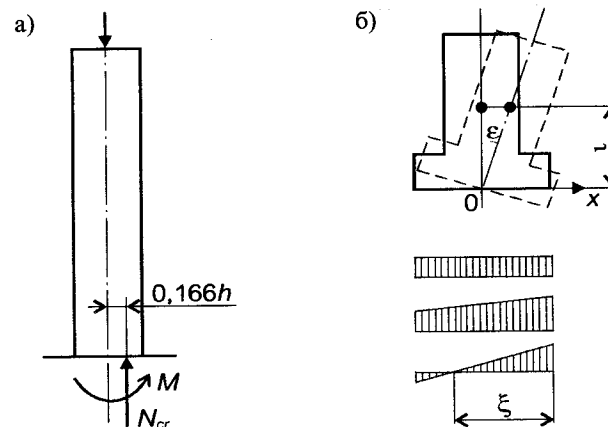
К расчету центрально-сжатых колонн, опирающихся на фундамент по работам [3] и [6]
